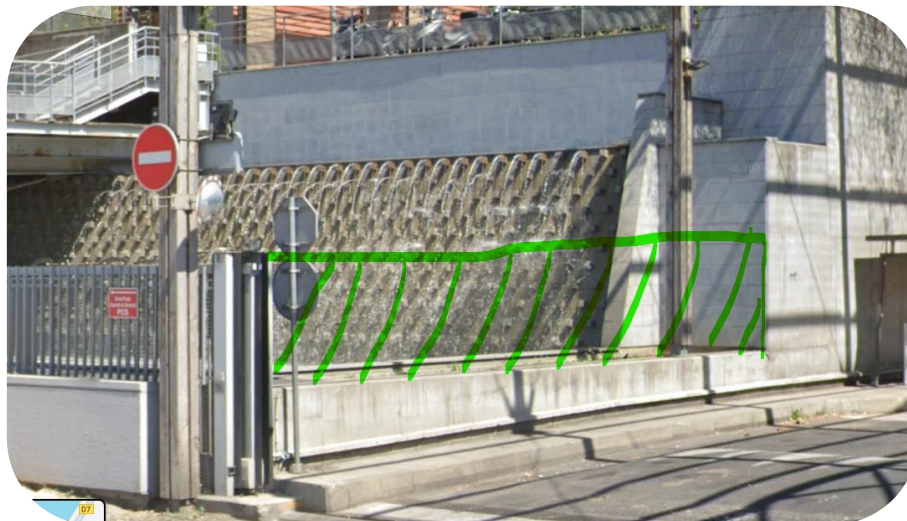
Futur installation de la grille en sortie de la voie BOM
